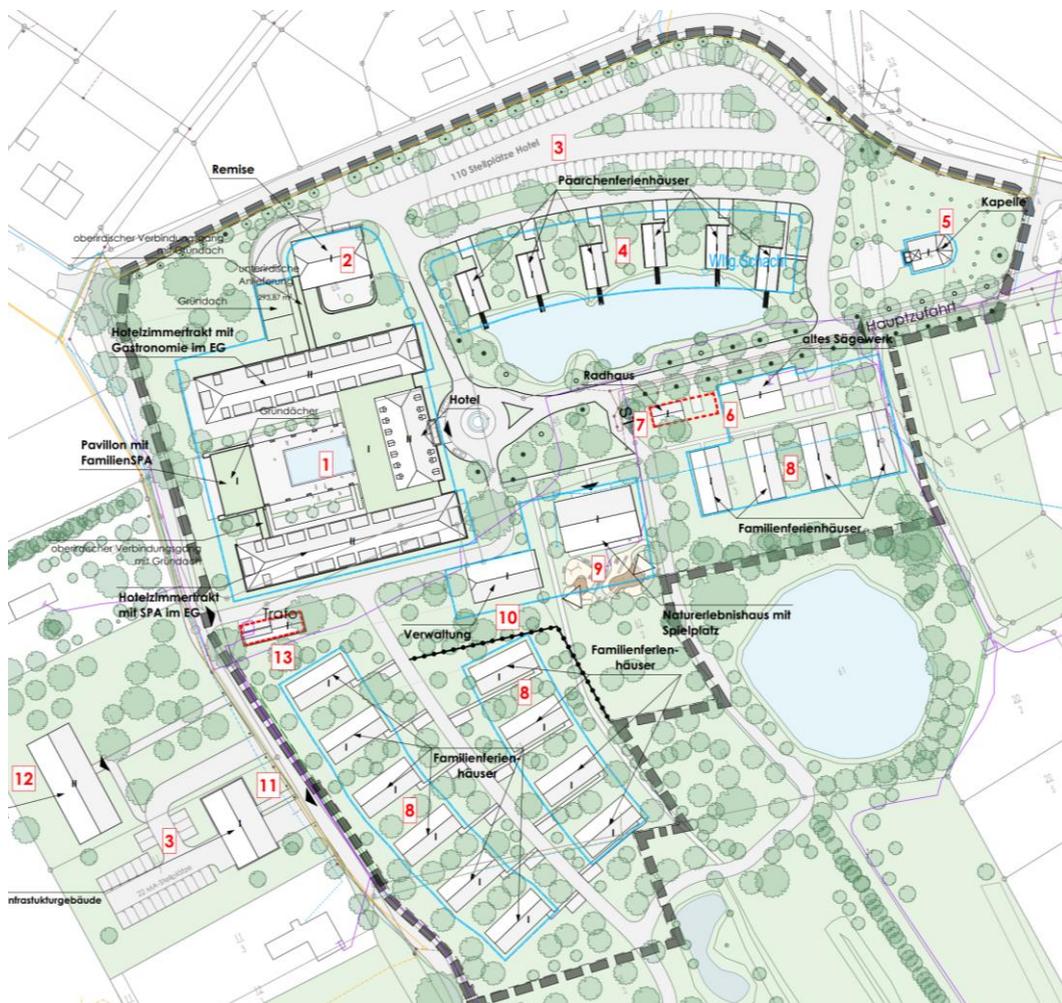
Ausschnitt Vorhaben- und Erschließungsplan; Plan W65 GmbH, 20.06.2024
